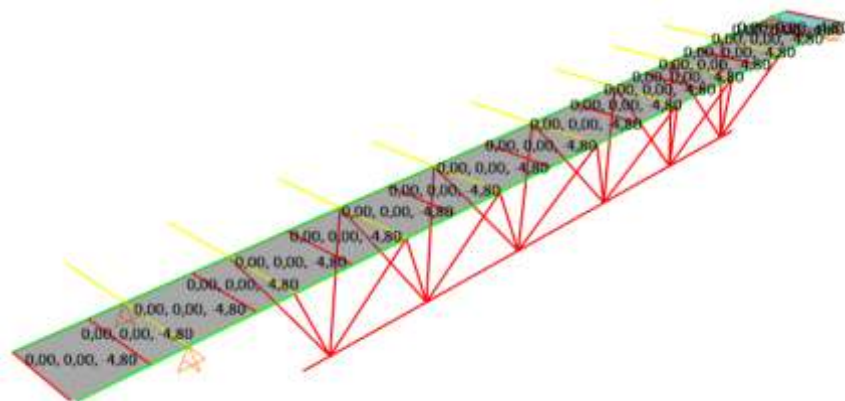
Beban Pemeliharaan (ML) yang diterima Struktur *Catwalk 10
